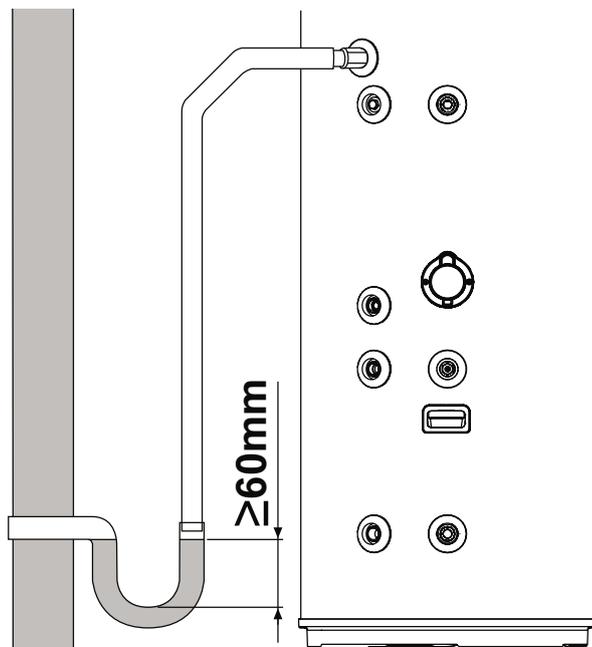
Esempi di collegamento di scarico della condensa attraverso un pozzetto di intercettazione
